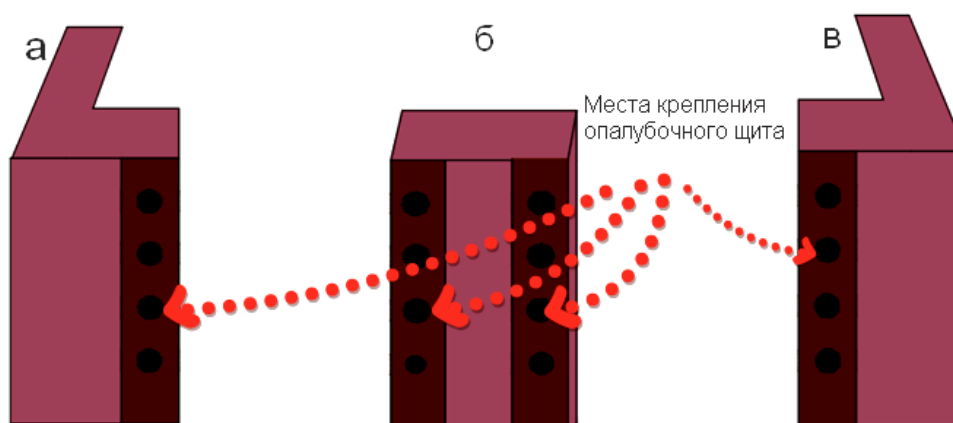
Фрагменты готовой части опалубки, изготовленные из PENOCOM[®]:
